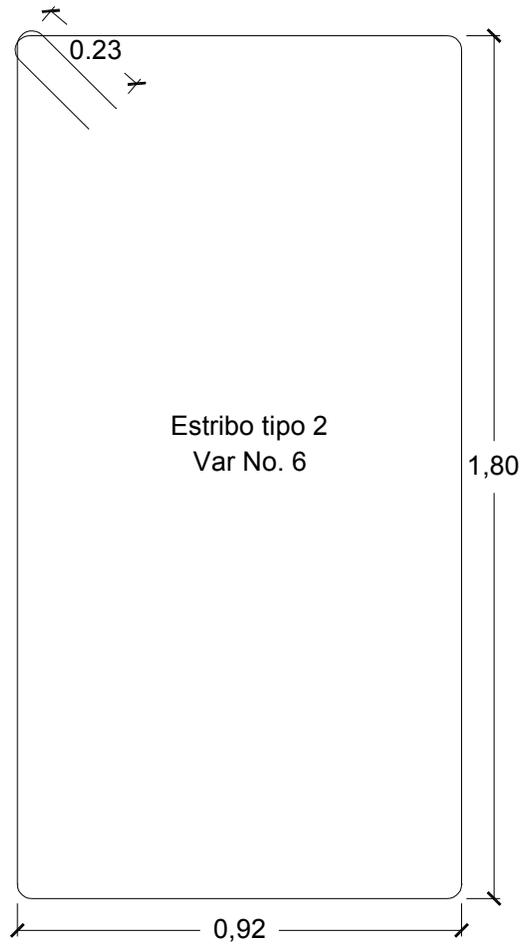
c. Estribo tipo 2, trabe de coronamiento.
